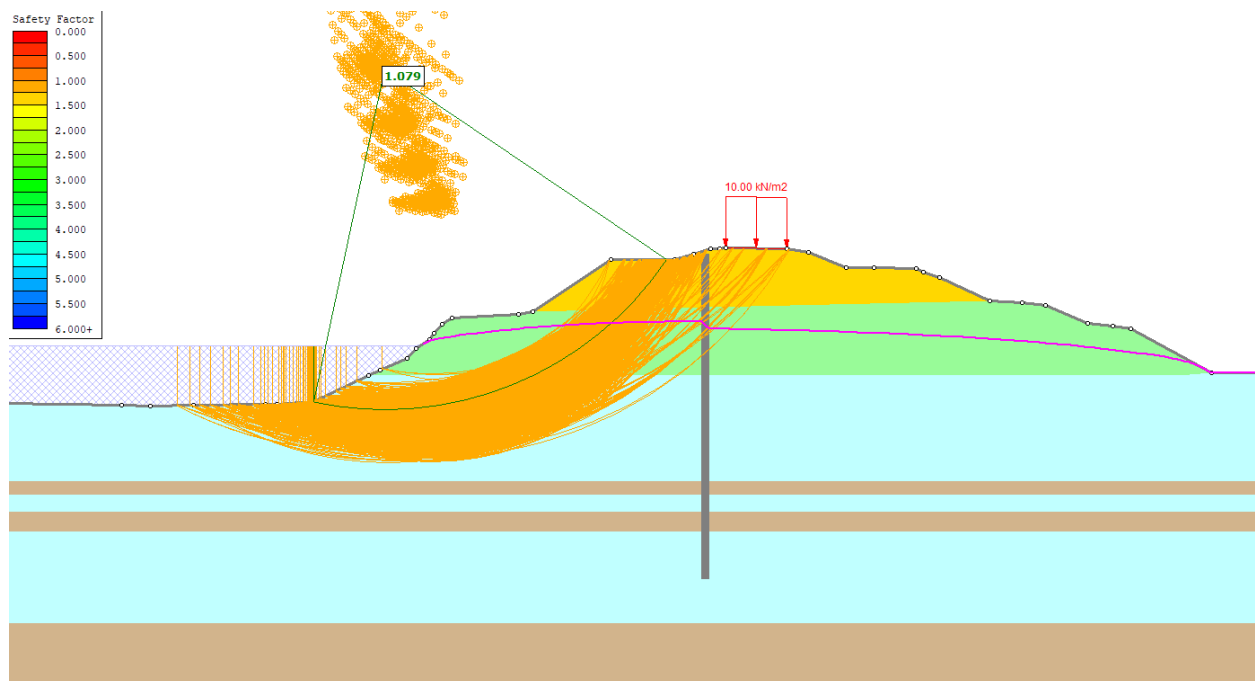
Sezione n.2 – Stato di progetto – Analisi statica di svasso rapido dalla quota di piena SIMPO '82 – Parametri drenati – Superfici di rottura con ODF < 1.2
